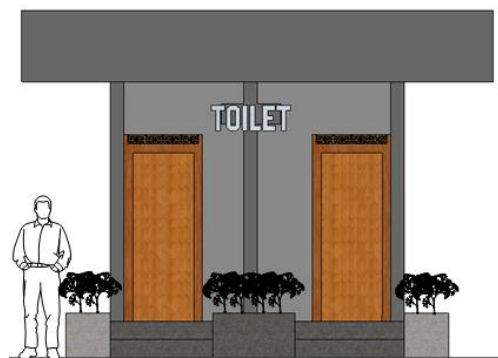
97. Tampak Depan Toilet Umum Alternatif 1
